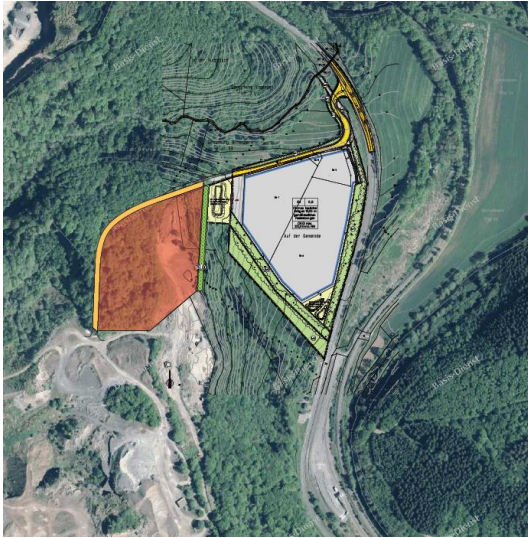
Standort I – ursprünglichen Planung mit östlich angrenzendem BPlan „GI -
